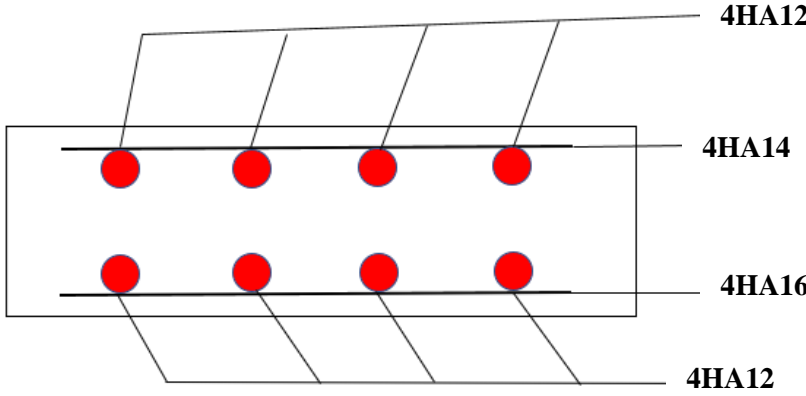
Ferrailage de la dalle dans le sens longitudinal
